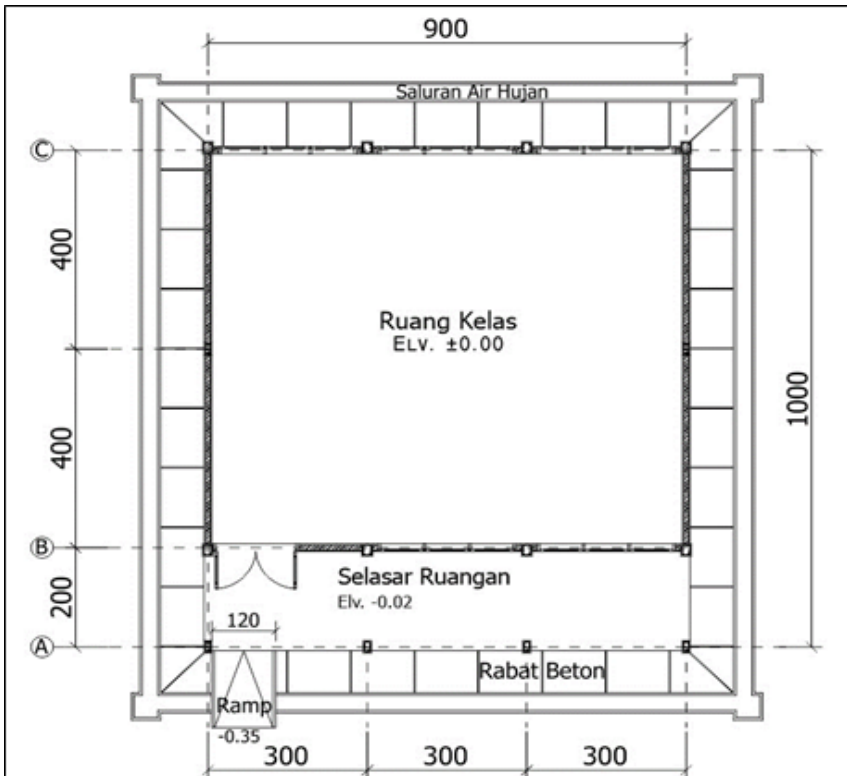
Contoh Denah RKB Bila Dibangun di Lantai 2 Bangunan Eksisting
